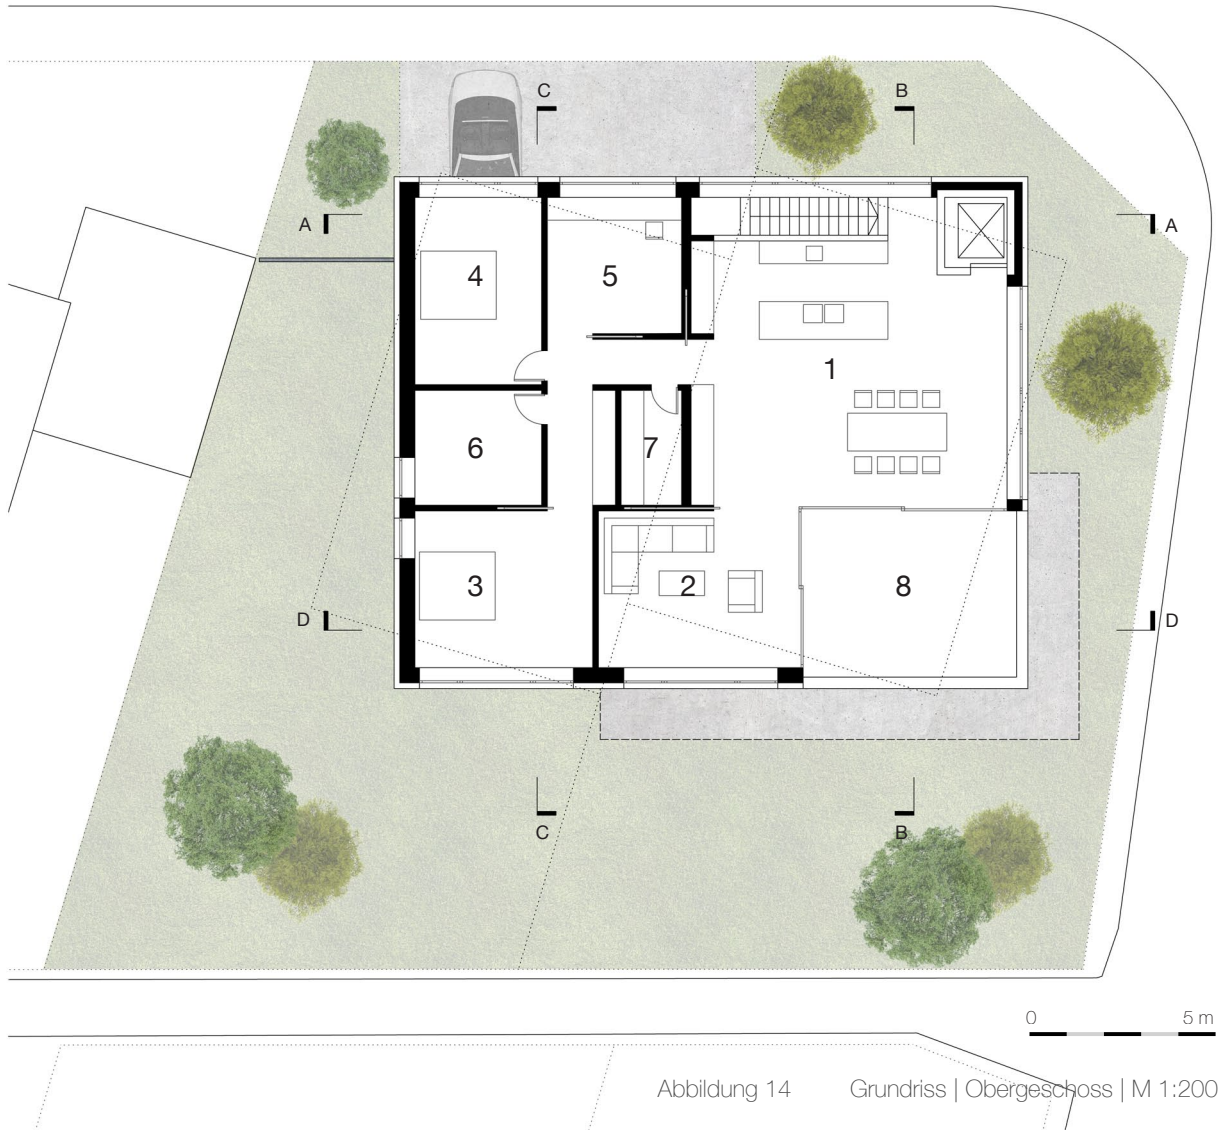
Grundriss | Obergeschoss | M 1:200
